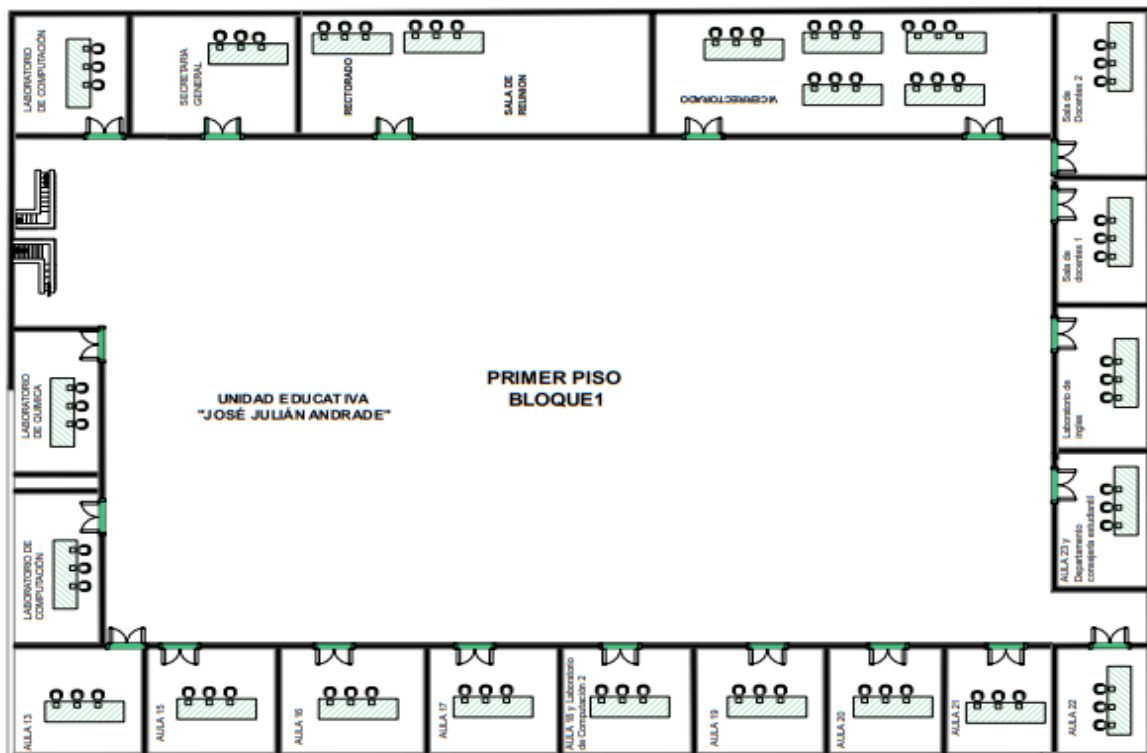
Plano de la estructura del bloque 1, primer piso de la institución.
